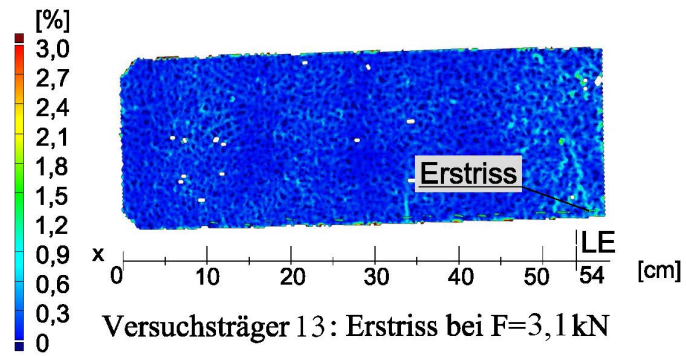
Versuchsträger 13- Lage Erstriss
